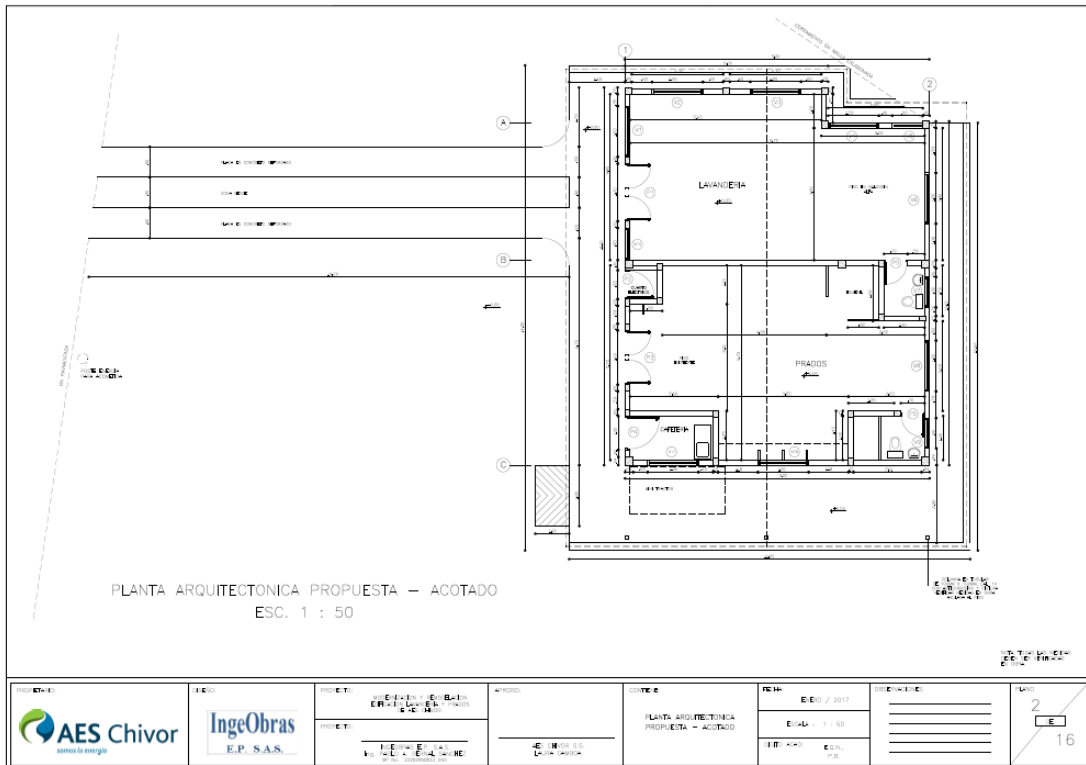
plano arquitectónico de proyección lavandería y prados. Fuente: AES Chivor
